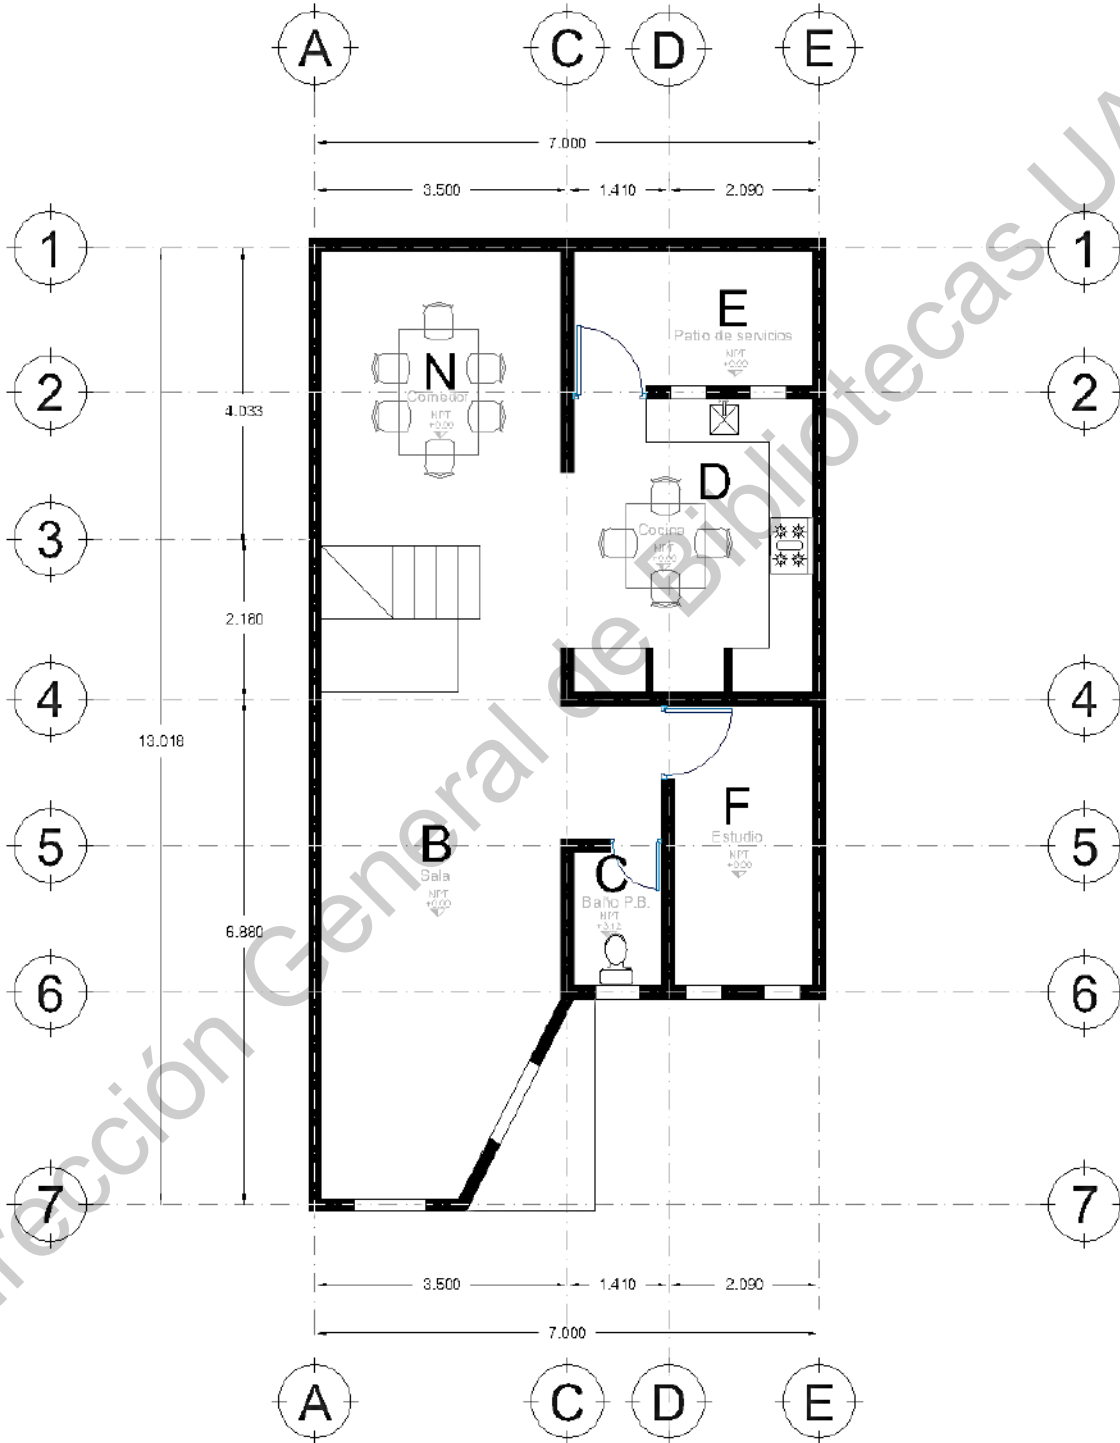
Planta Arquitectónica Baja. Casa Prototipo
